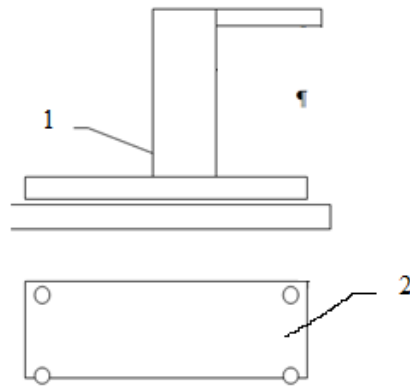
Расчетная схема: 1 – стойка; 2- бетонное основание
